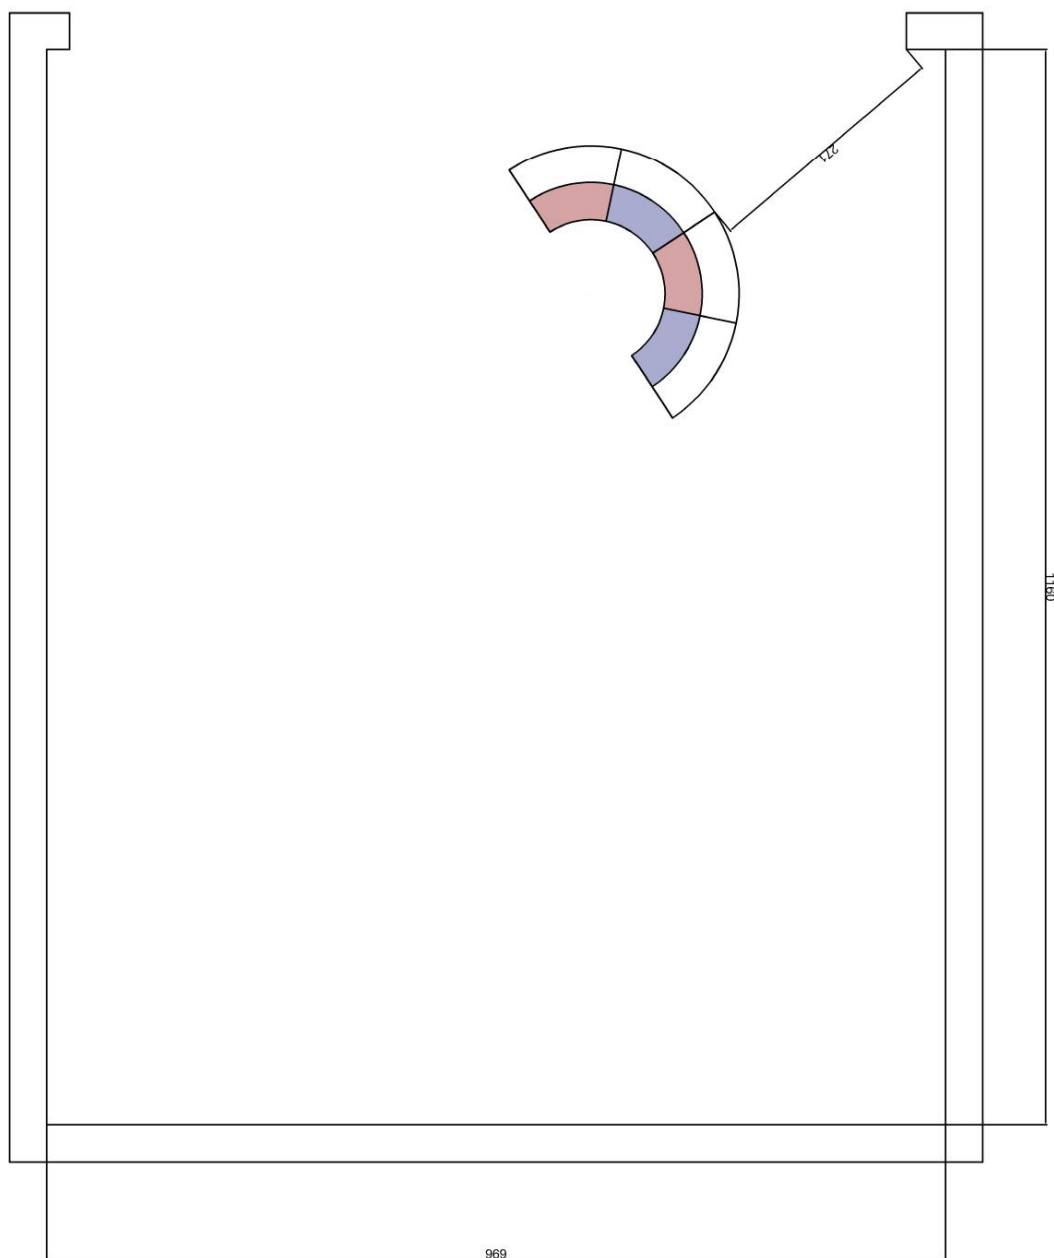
Planimetria ambiente polifunzionale con arena semicircolare
